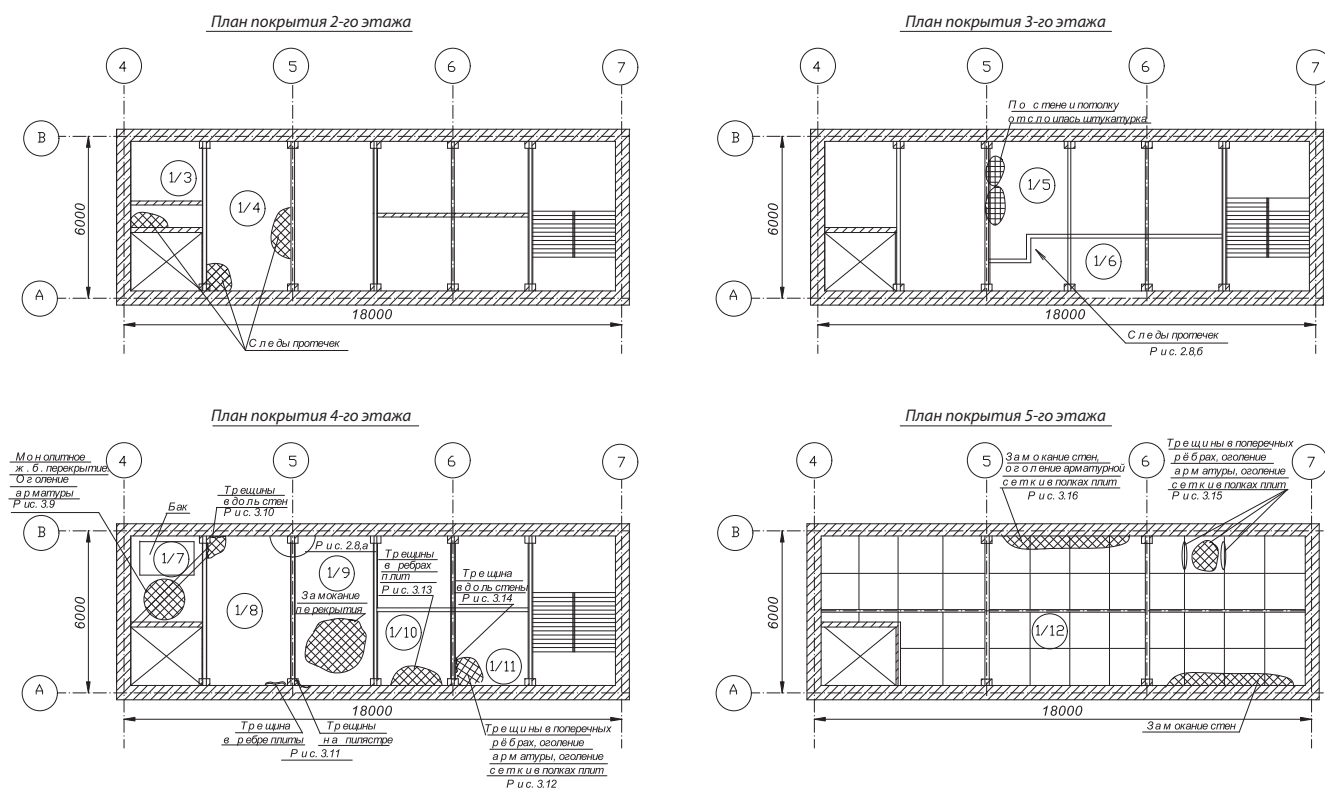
Схематические планы покрытий пятиэтажного здания «Хрустальный участка» с выявленными дефектами и повреждениями
